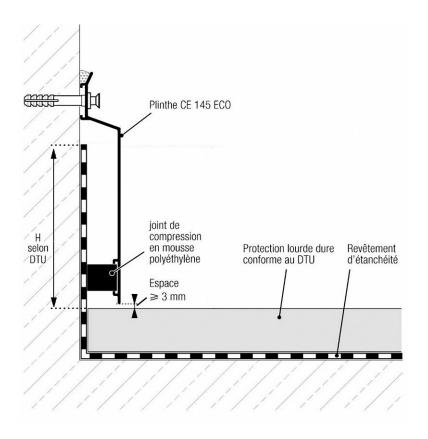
Toiture-terrasse accessible aux véhicules légers Joint de compression (cf. § 4.4.6)
